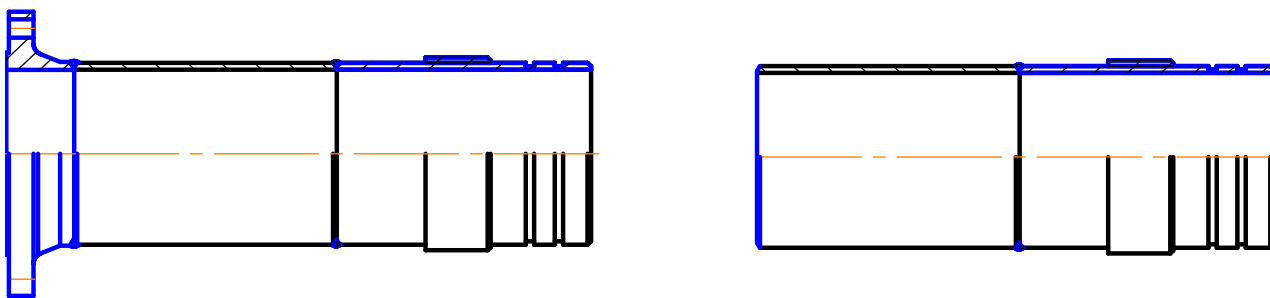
Варианты перехода со стеклопластикового трубопровода на трубопроводную арматуру или металлический трубопровод
